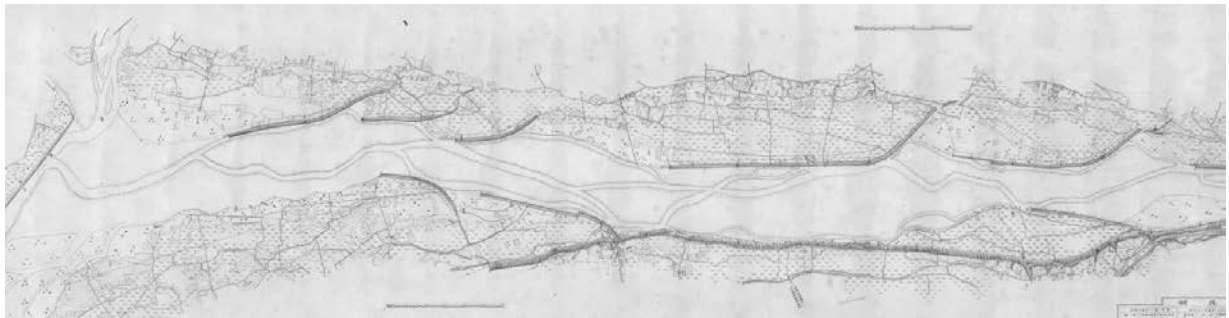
大正6年の三峰川 伊那市付近の状況（左端が天竜川との合流点、三峰川平面図 長測図 768）
